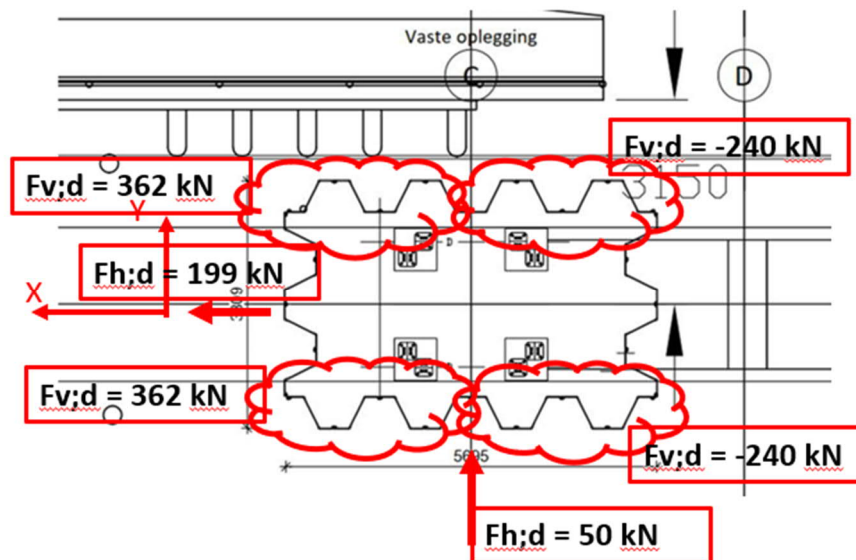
bovenanzicht schets fundatie damwandconstructie - westzijde
